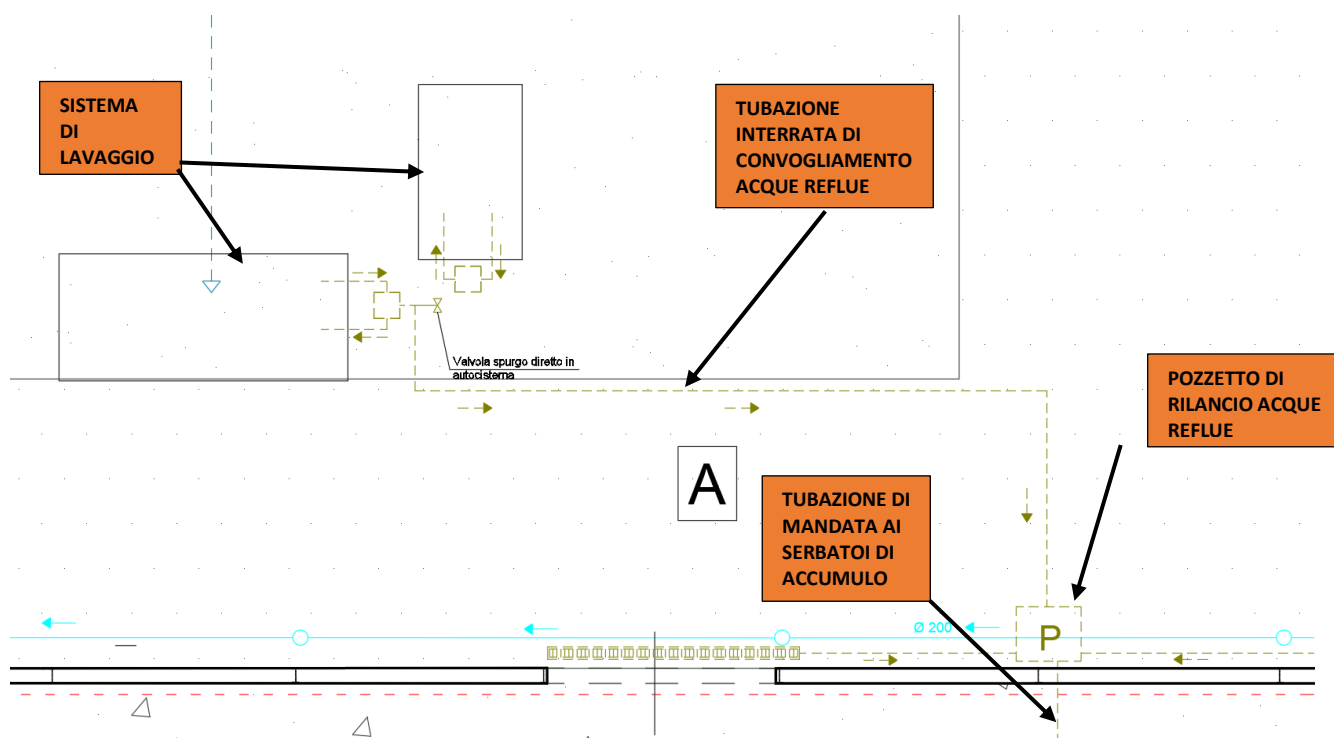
Stralcio planimetrico con indicazione dei sistemi di adduzione delle acque reflue prodotte dalla linea M2
